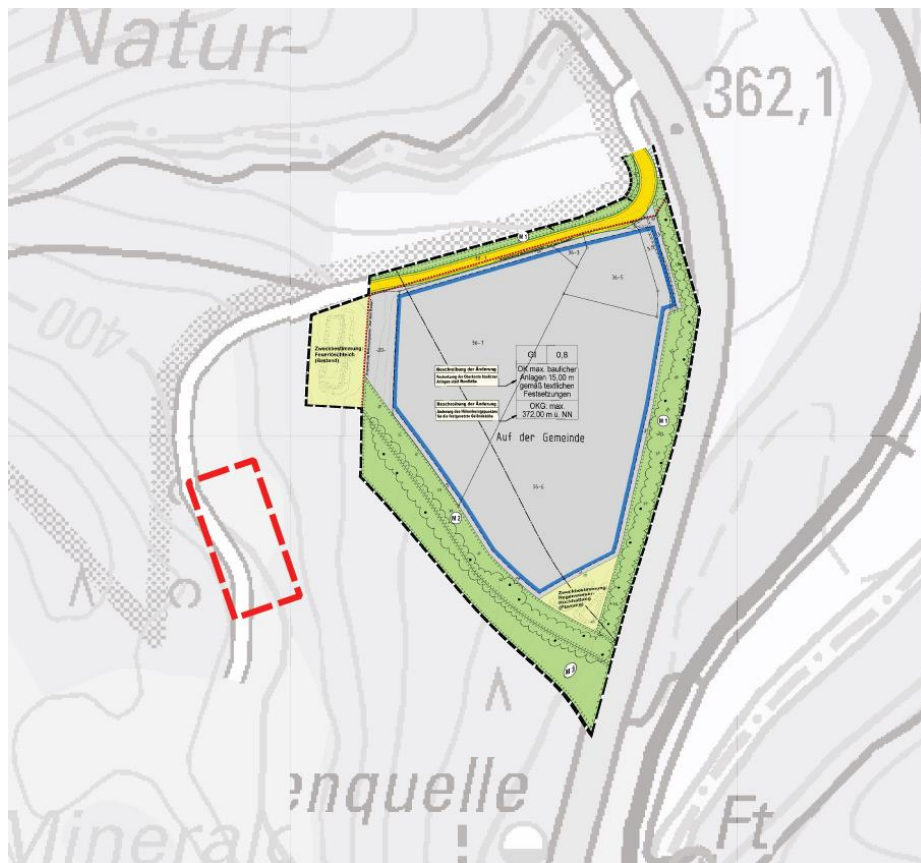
Geltungsbereich der vorliegenden Planung mit angrenzendem Bebauungsplan "Auf dem Boden"
